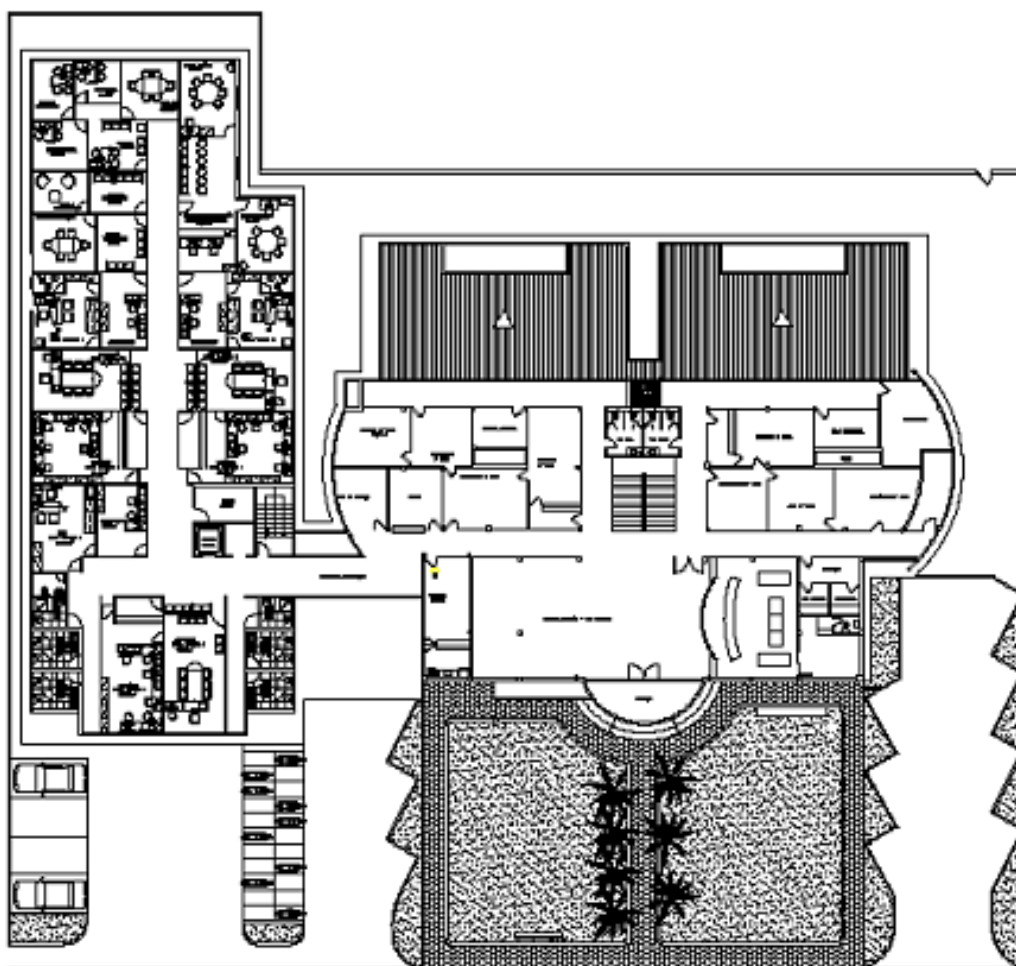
Fórum de Sousa – Planta Baixa Térreo
